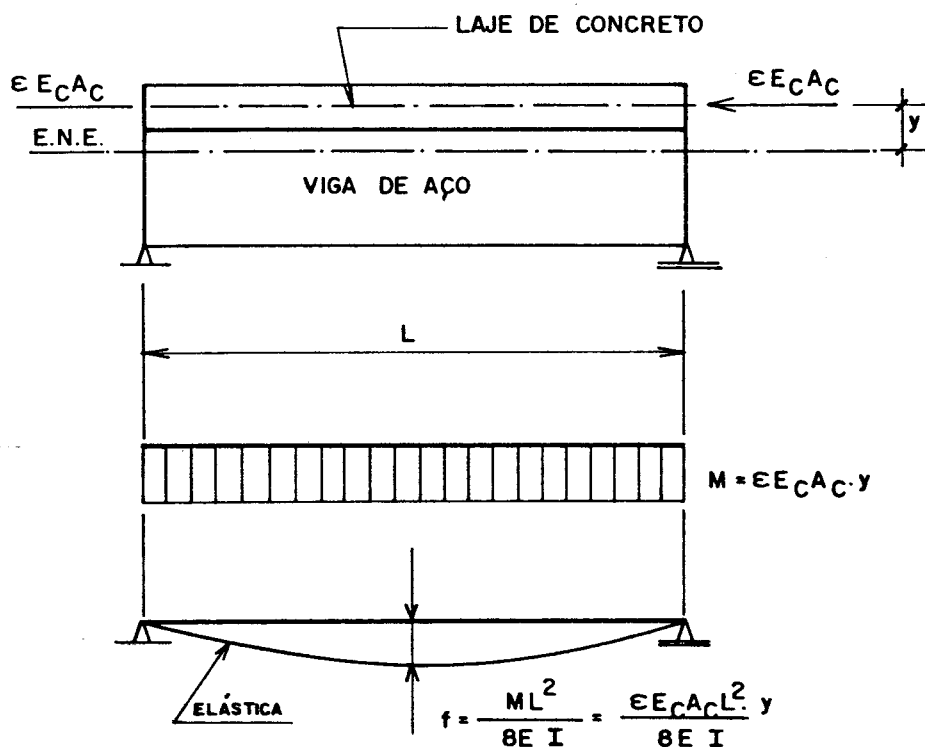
EFEITO DA RETRAÇÃO DO CONCRETO EM VIGAS MISTAS SEGUNDO A CAN [12]
